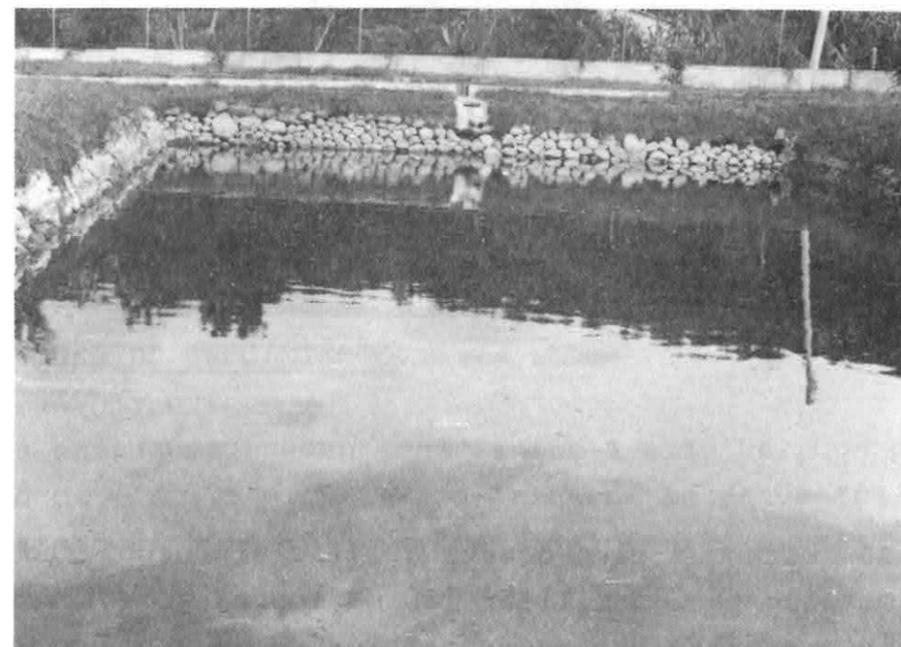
Estanque semirústico con paredes de mampostería y fondo de tierra.
